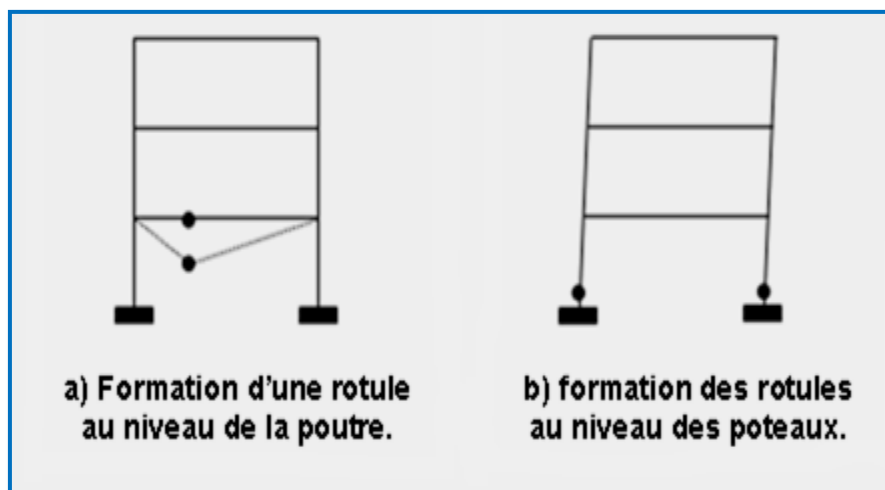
Formation des rotules plastiques dans les poteaux et les poutres.
